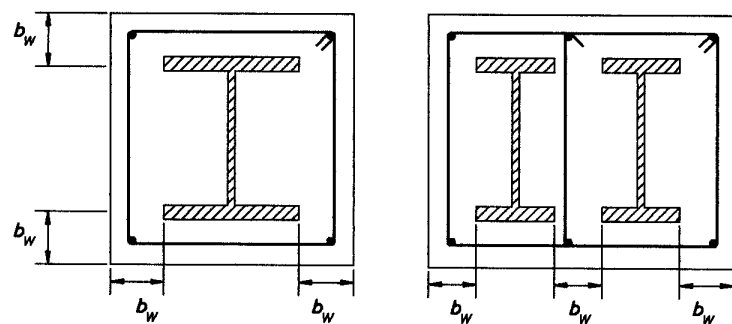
Anchos efectivos para el cálculo de la resistencia al corte en columnas de sección mixta.
